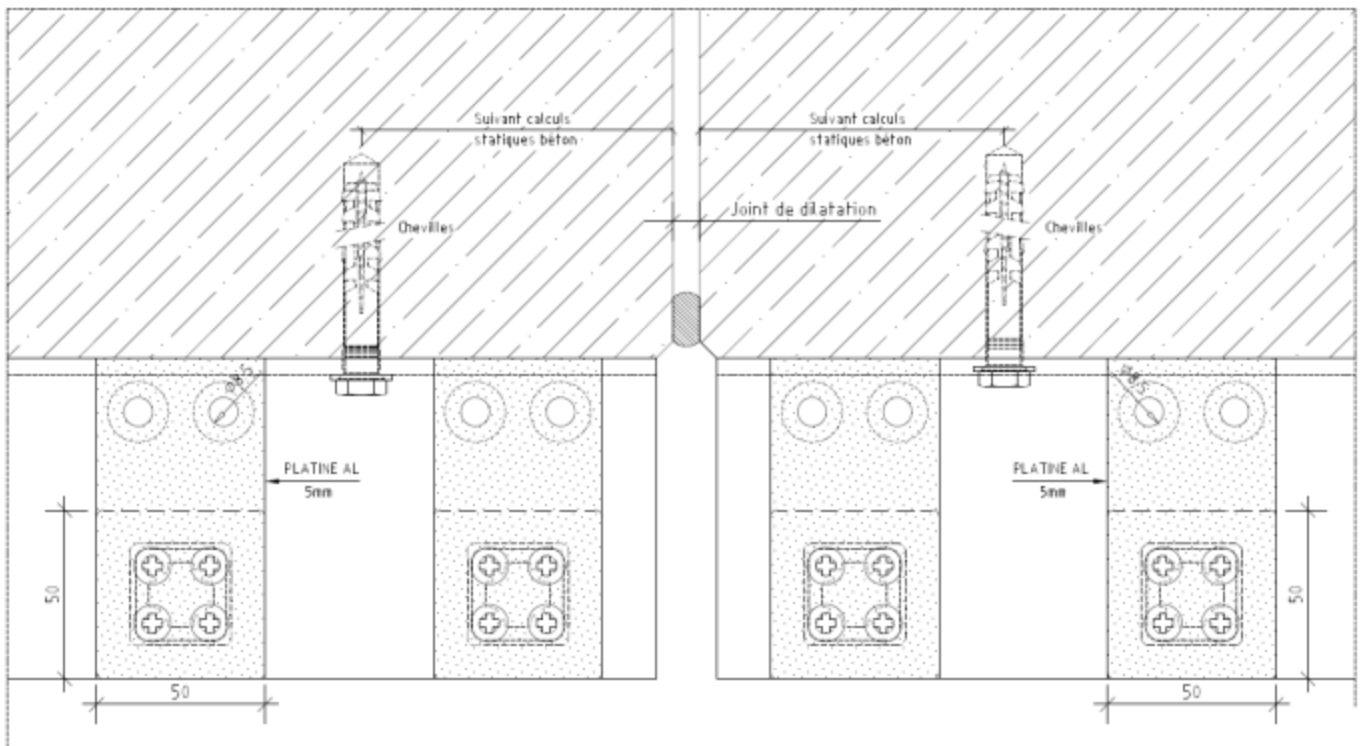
Traitement du joint de dilatation – pose verticale des baguettes – Fixation par platine
